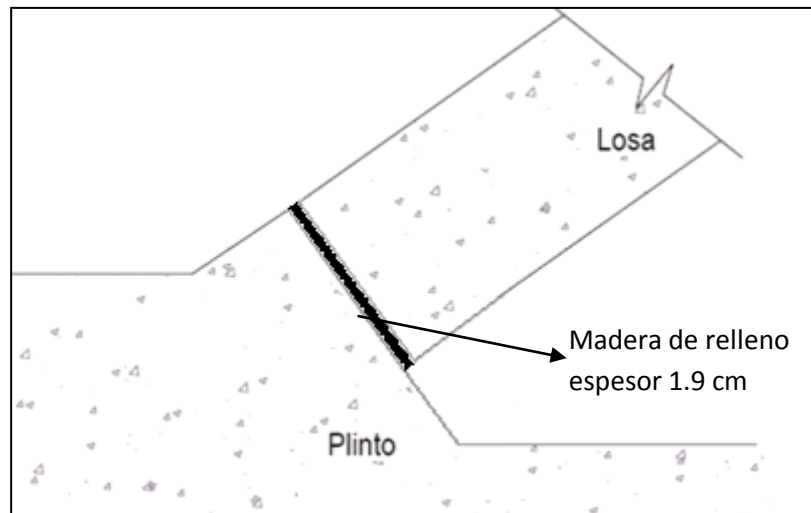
Detalle de la colocación de la madera de relleno.
